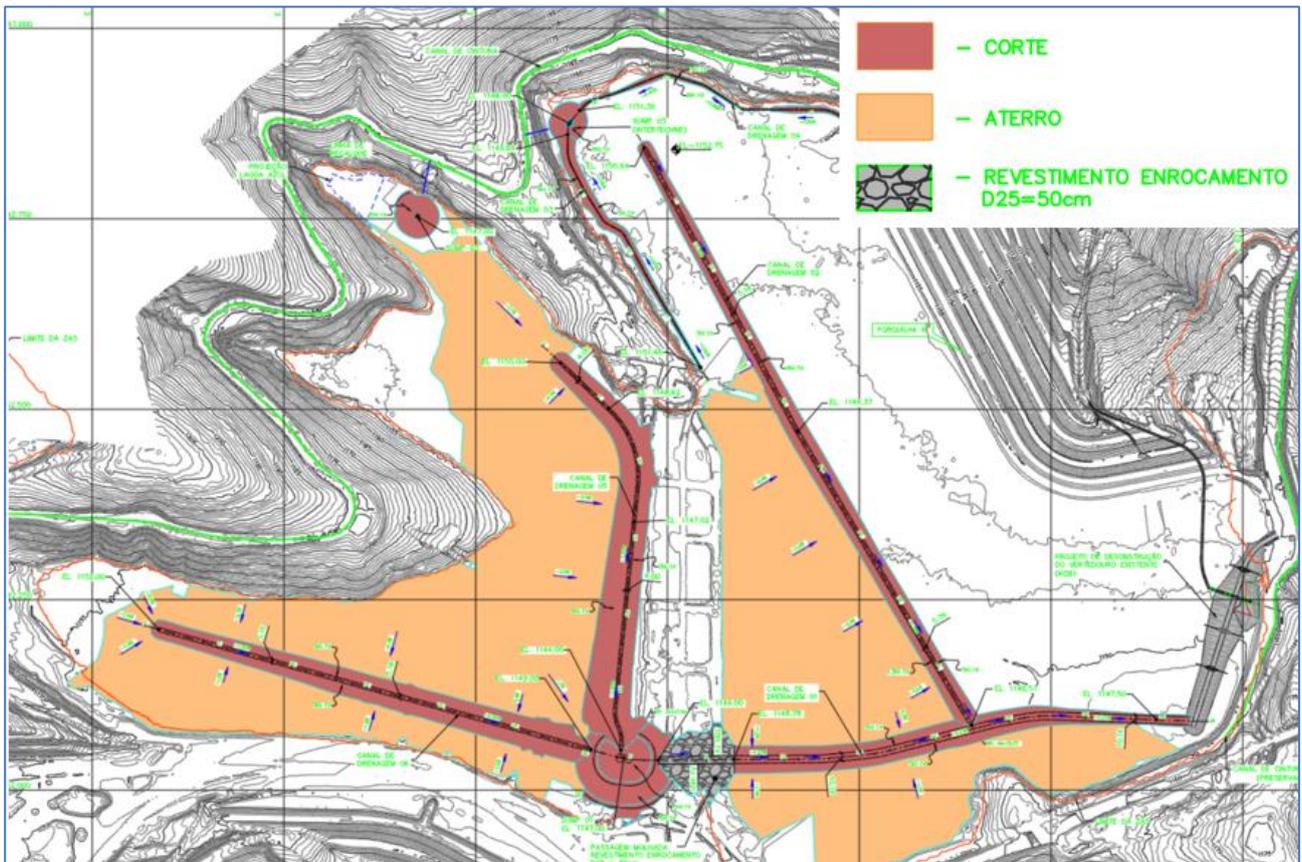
Planta geral do PPC 24/25 (INTT, 1850HH-X-40495) – Escavação e disposição interna dos rejeitos.
